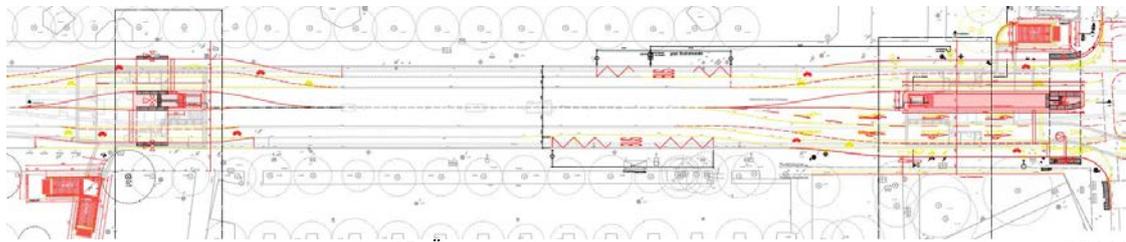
Übersicht Standortvarianten, Variante I und II, Ausschnitt Plan He\_PG001
